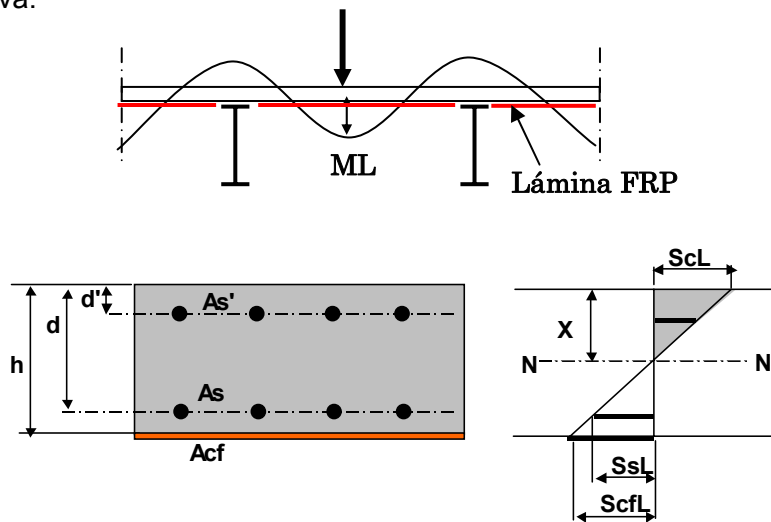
Momento y esfuerzo debido a la carga viva
